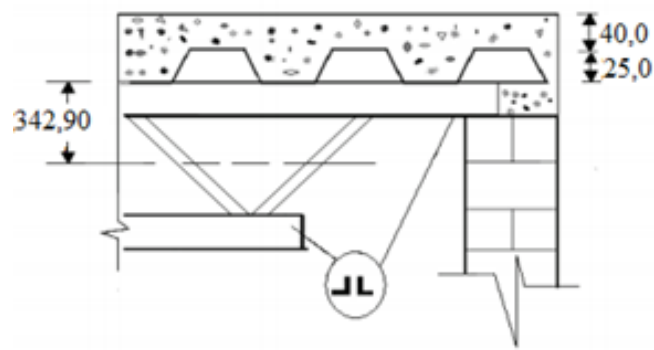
Detalhe do apoio do piso misto. Dimensões em mm.
